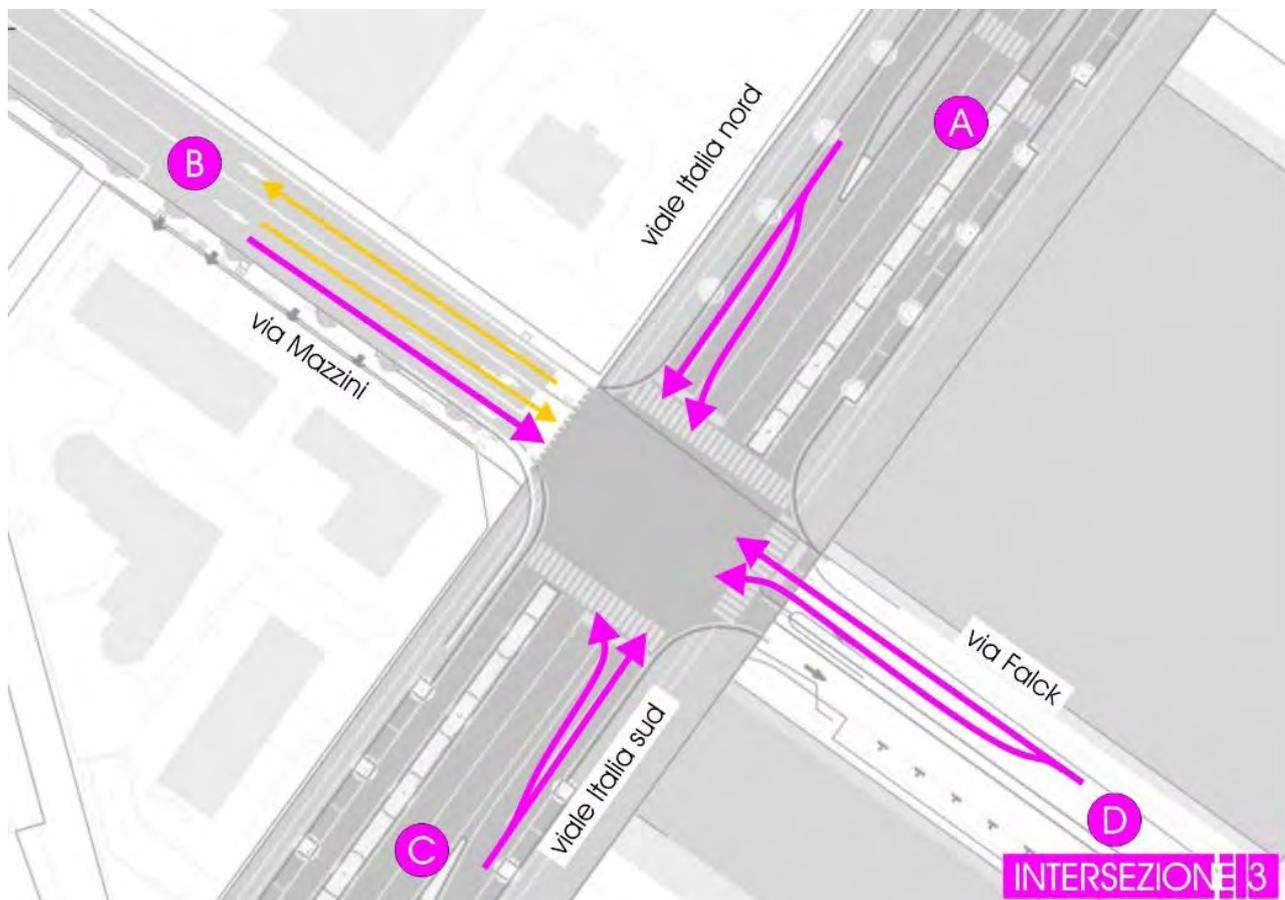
Scenario di Intervento 2 – Planimetria intersezione 3
